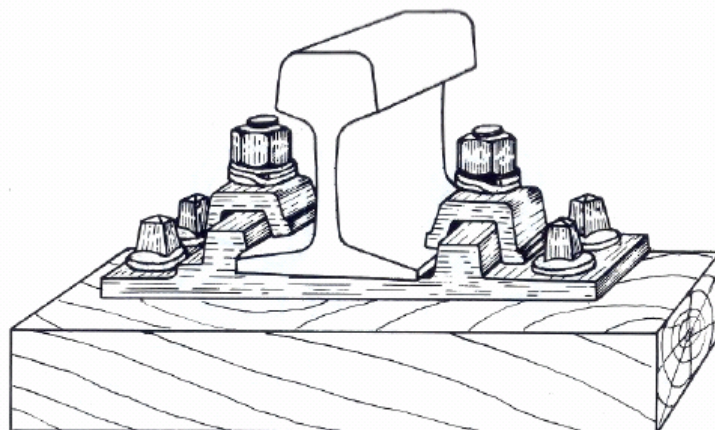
Detalhe do lastro, dormente, trilhos e acessórios de fixação.
